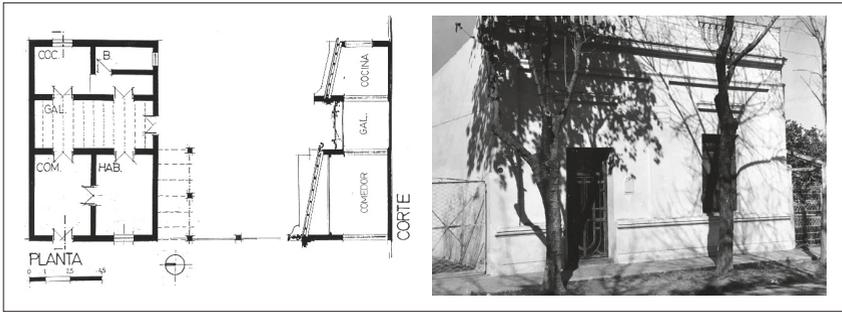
Planta, corte y fotografía. Casa del padre Mendoza (1989)
